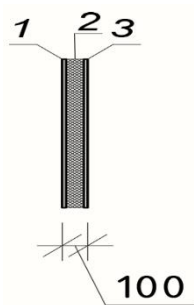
Схема конструкции ограждающей конструкции наружных стен
